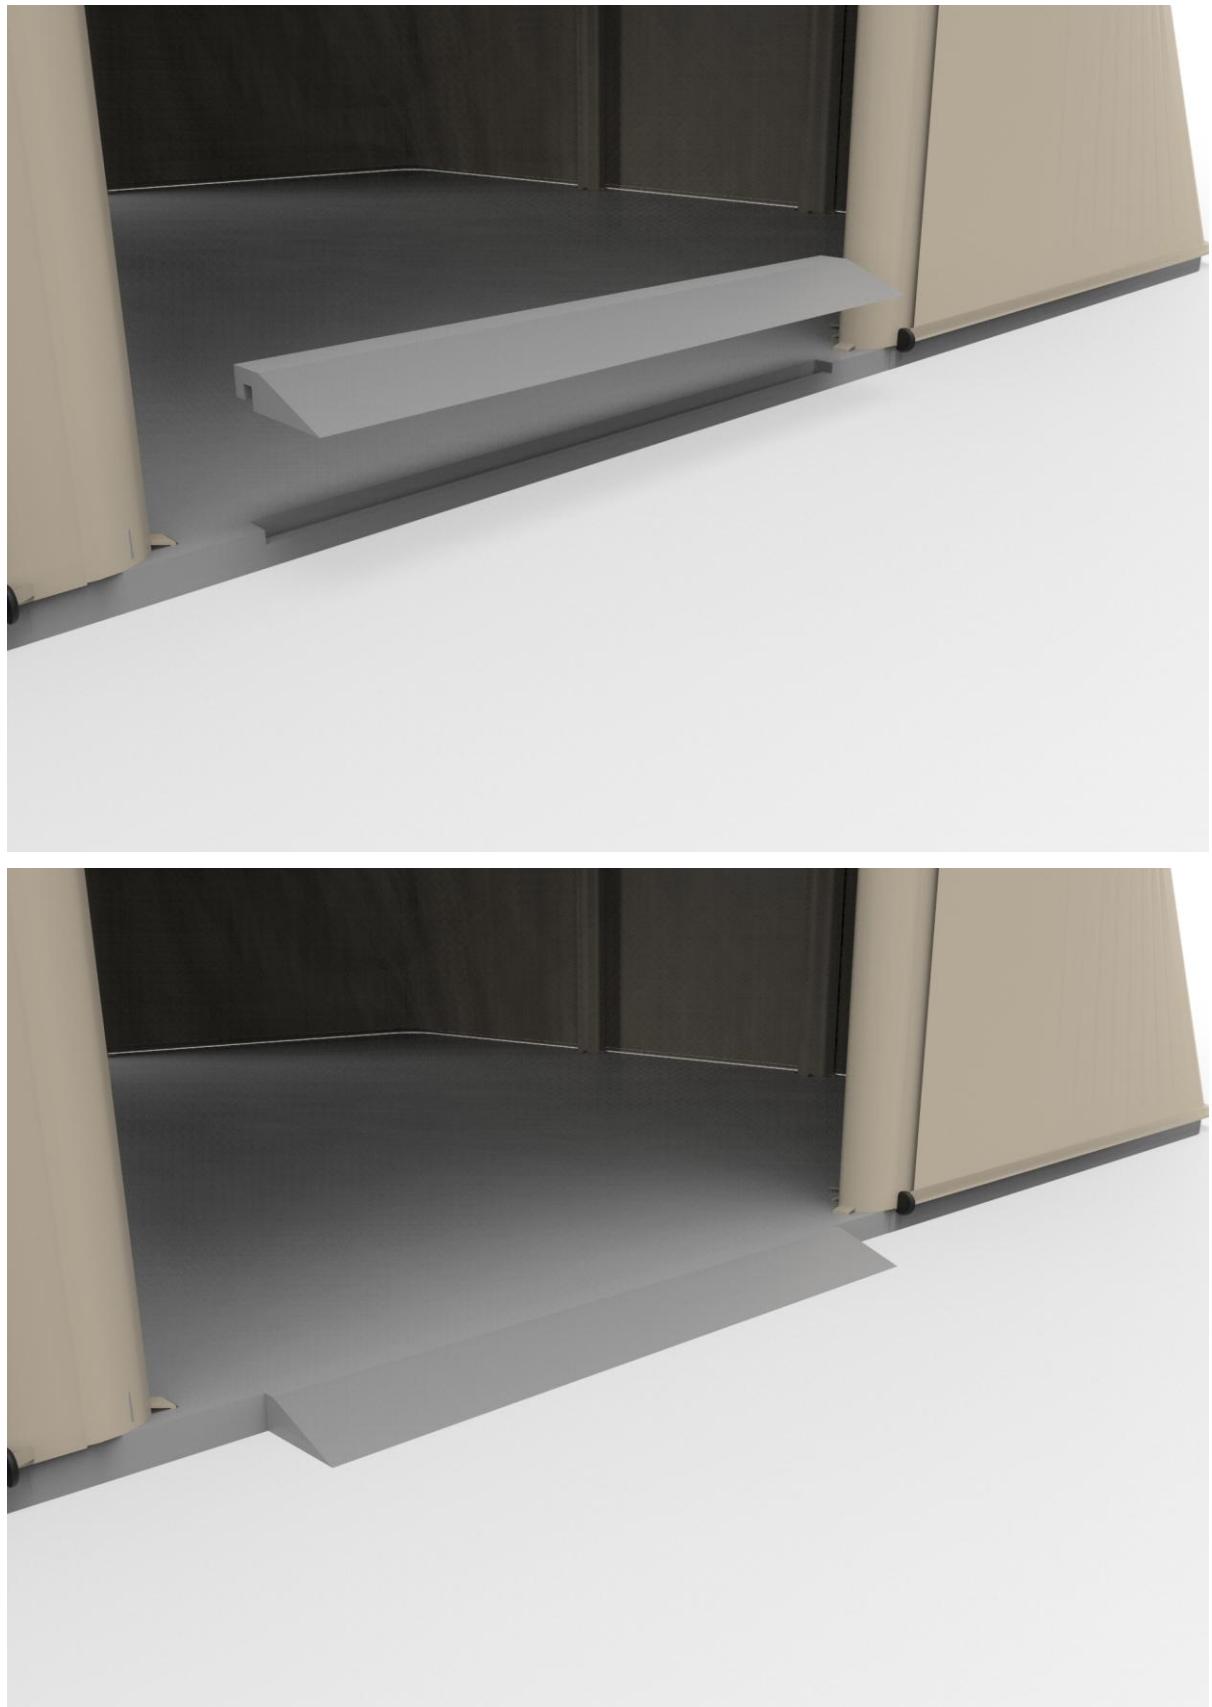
Perfuração no estrado, para a colocação da rampa ou extensão do estrado.
